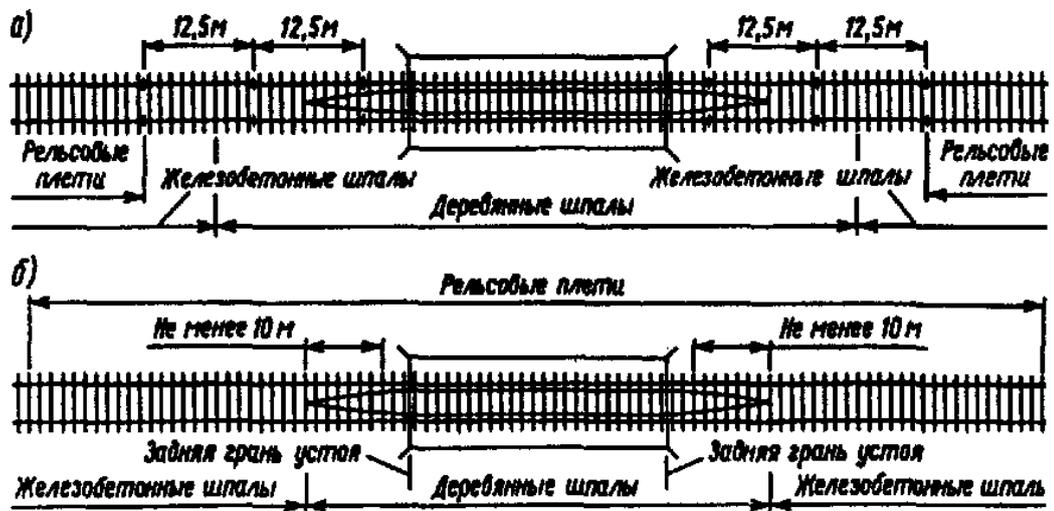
Схемы расположения железобетонных и деревянных шпал при примыкании рельсовых плетей к мостам (а) и при перекрытии мостов рельсовыми плетями (б)
